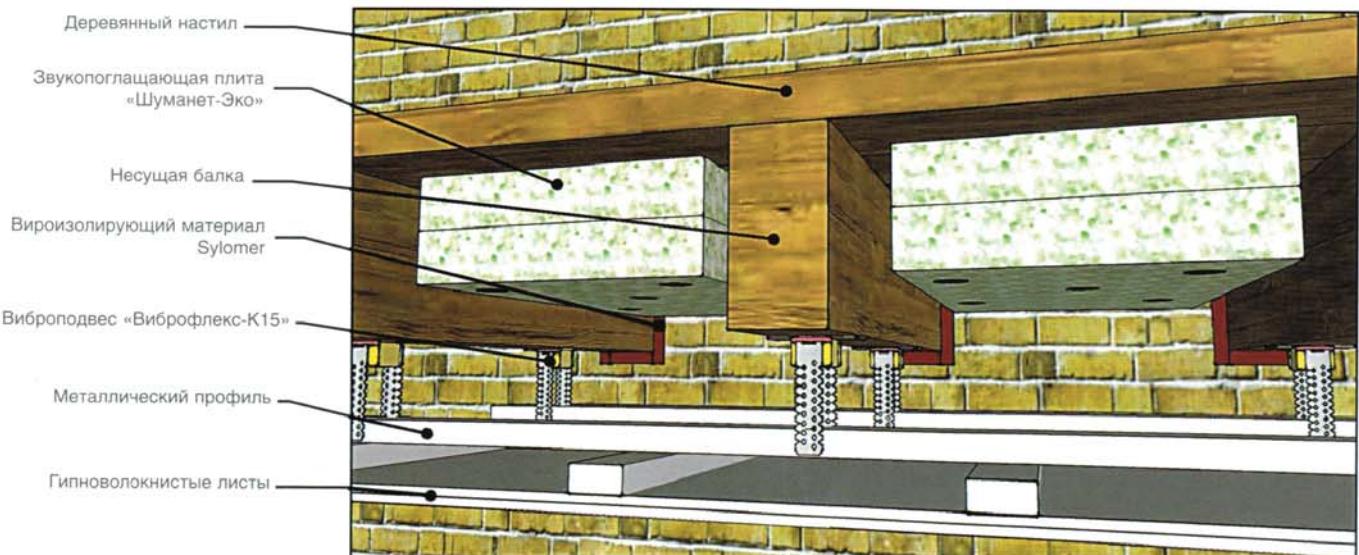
б. Конструкция перекрытия со звукоизолирующим подвесным потолком
